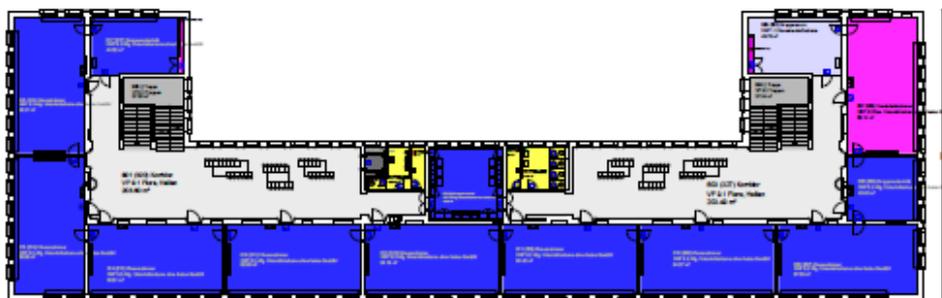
Grundriss 2. OG Schulanlage Milchbuck A+B (Zürich)
